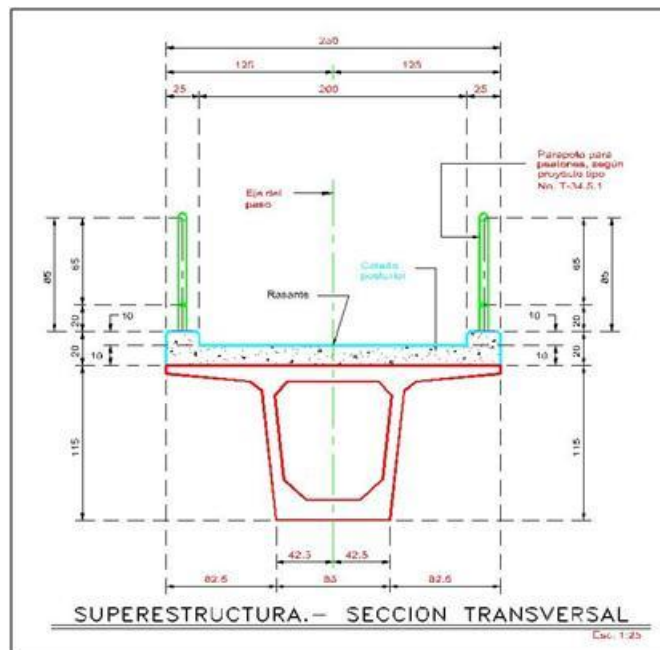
Detalle estructural de las travesas superiores del puente (PIP)
